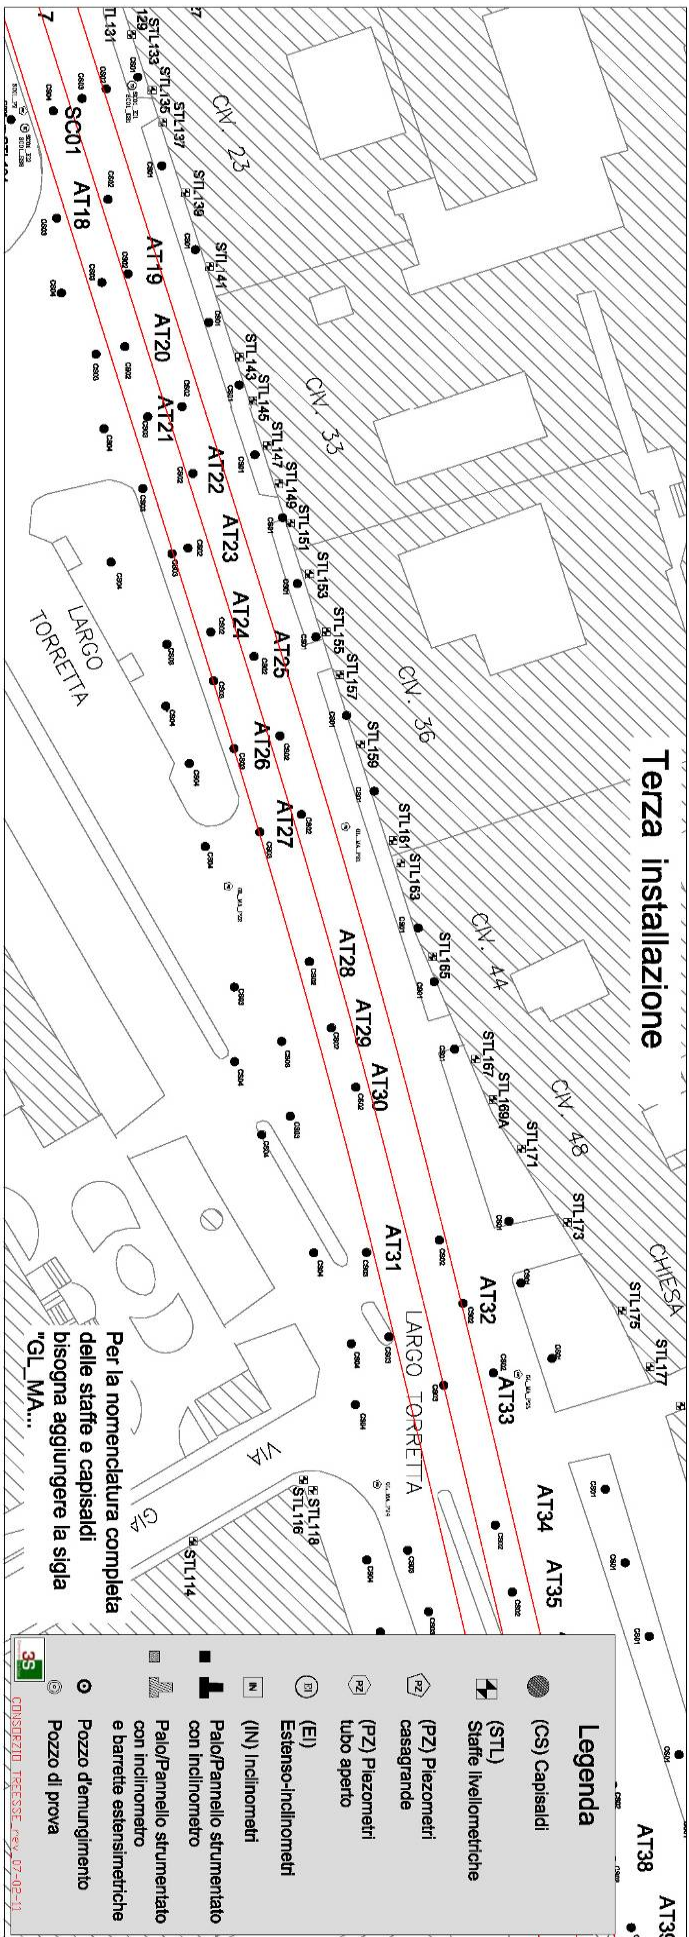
Planimetria tratta Mergellina - Arco Mirelli, raffigurante la disposizione della terza installazione della strumentazione di monitoraggio.
